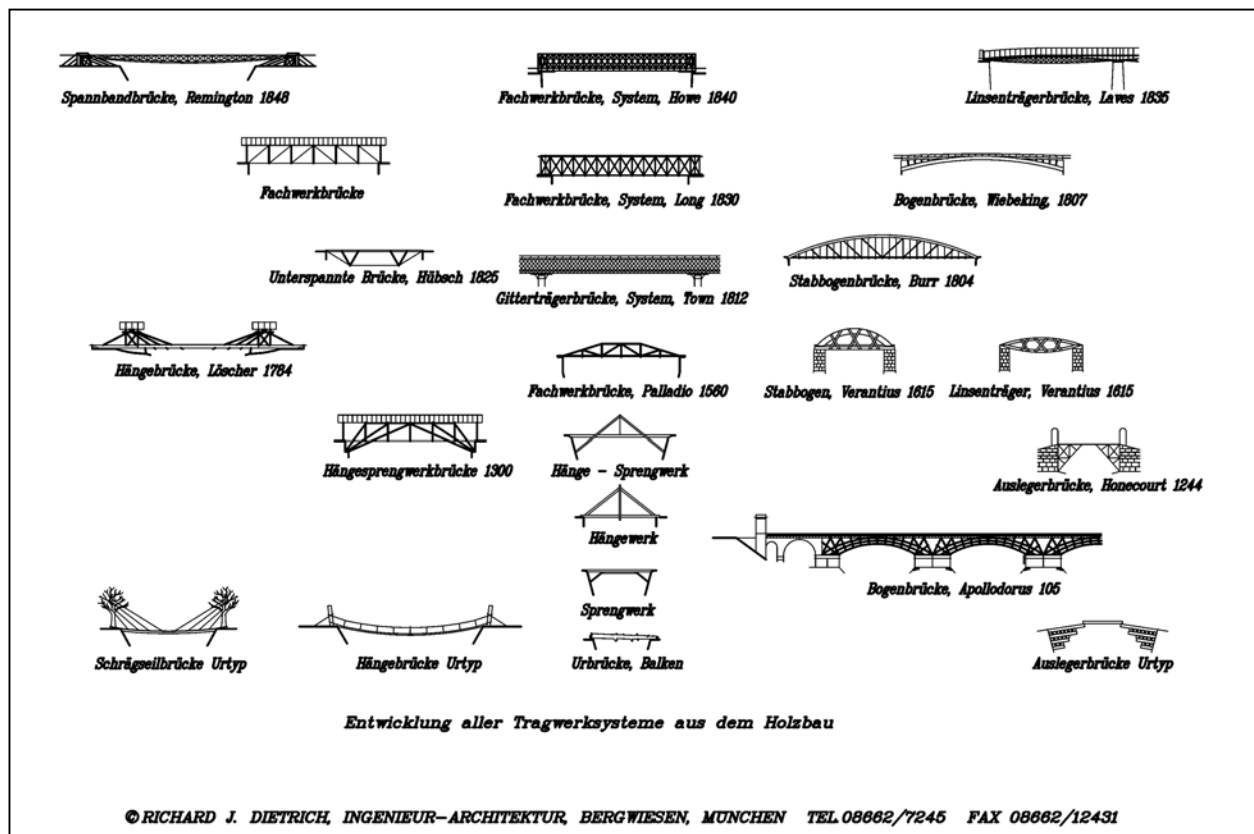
Stammbaum der Brücken, Ausschnitt Holzbrücken
